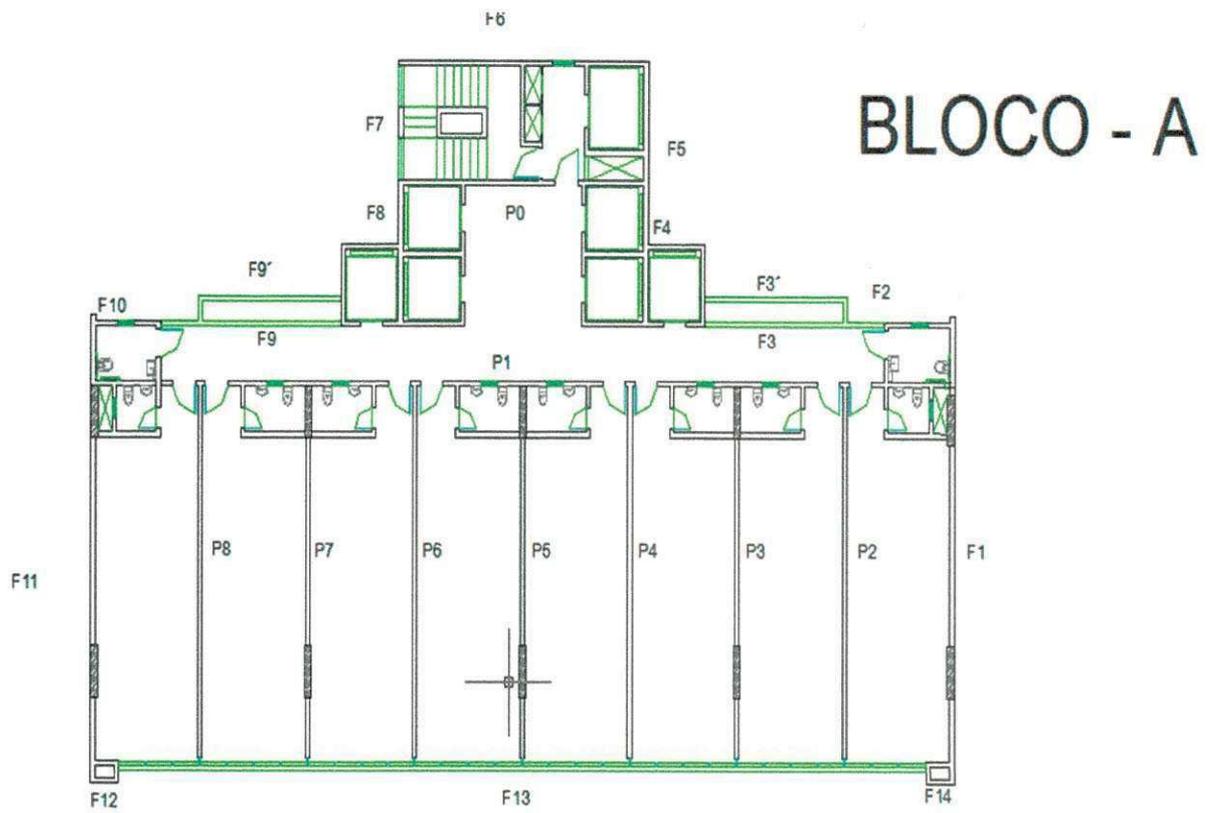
Planta baixa - Mundo Plaza (Bloco A).
